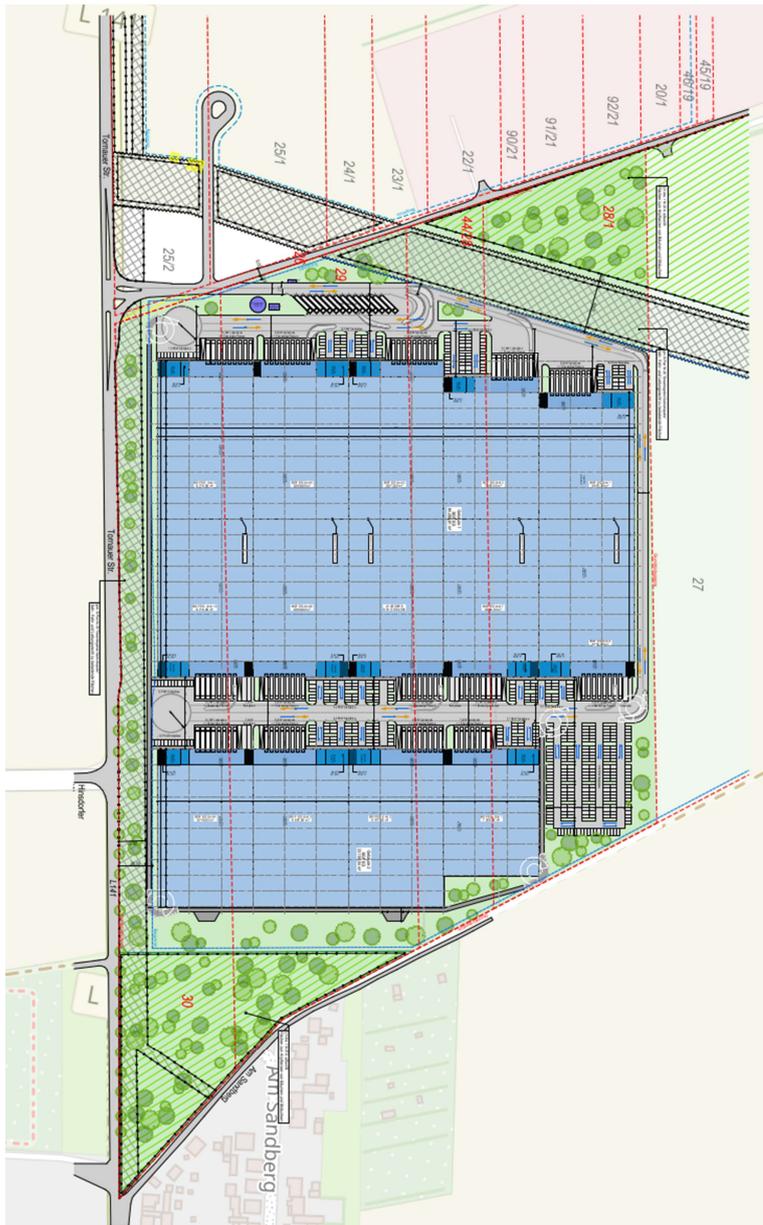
Lageplan „23046 – Gewerbepark Zörbig, P3“ der Firma Planquadrat
